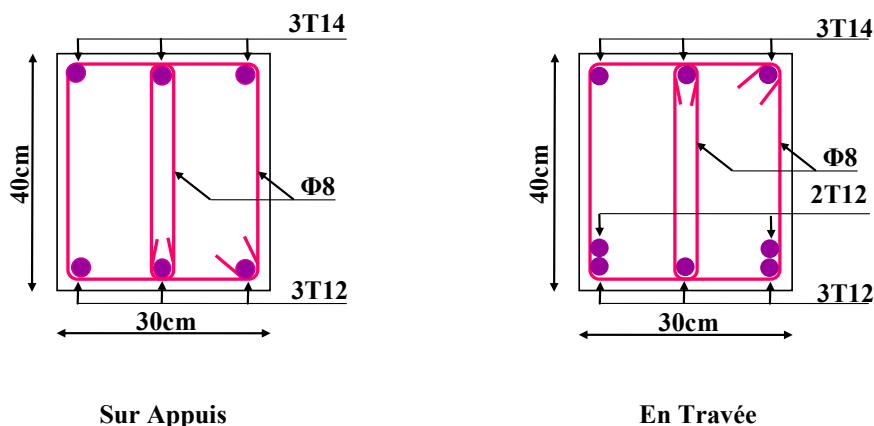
Ferrailage des poutres (30x40)cm².
